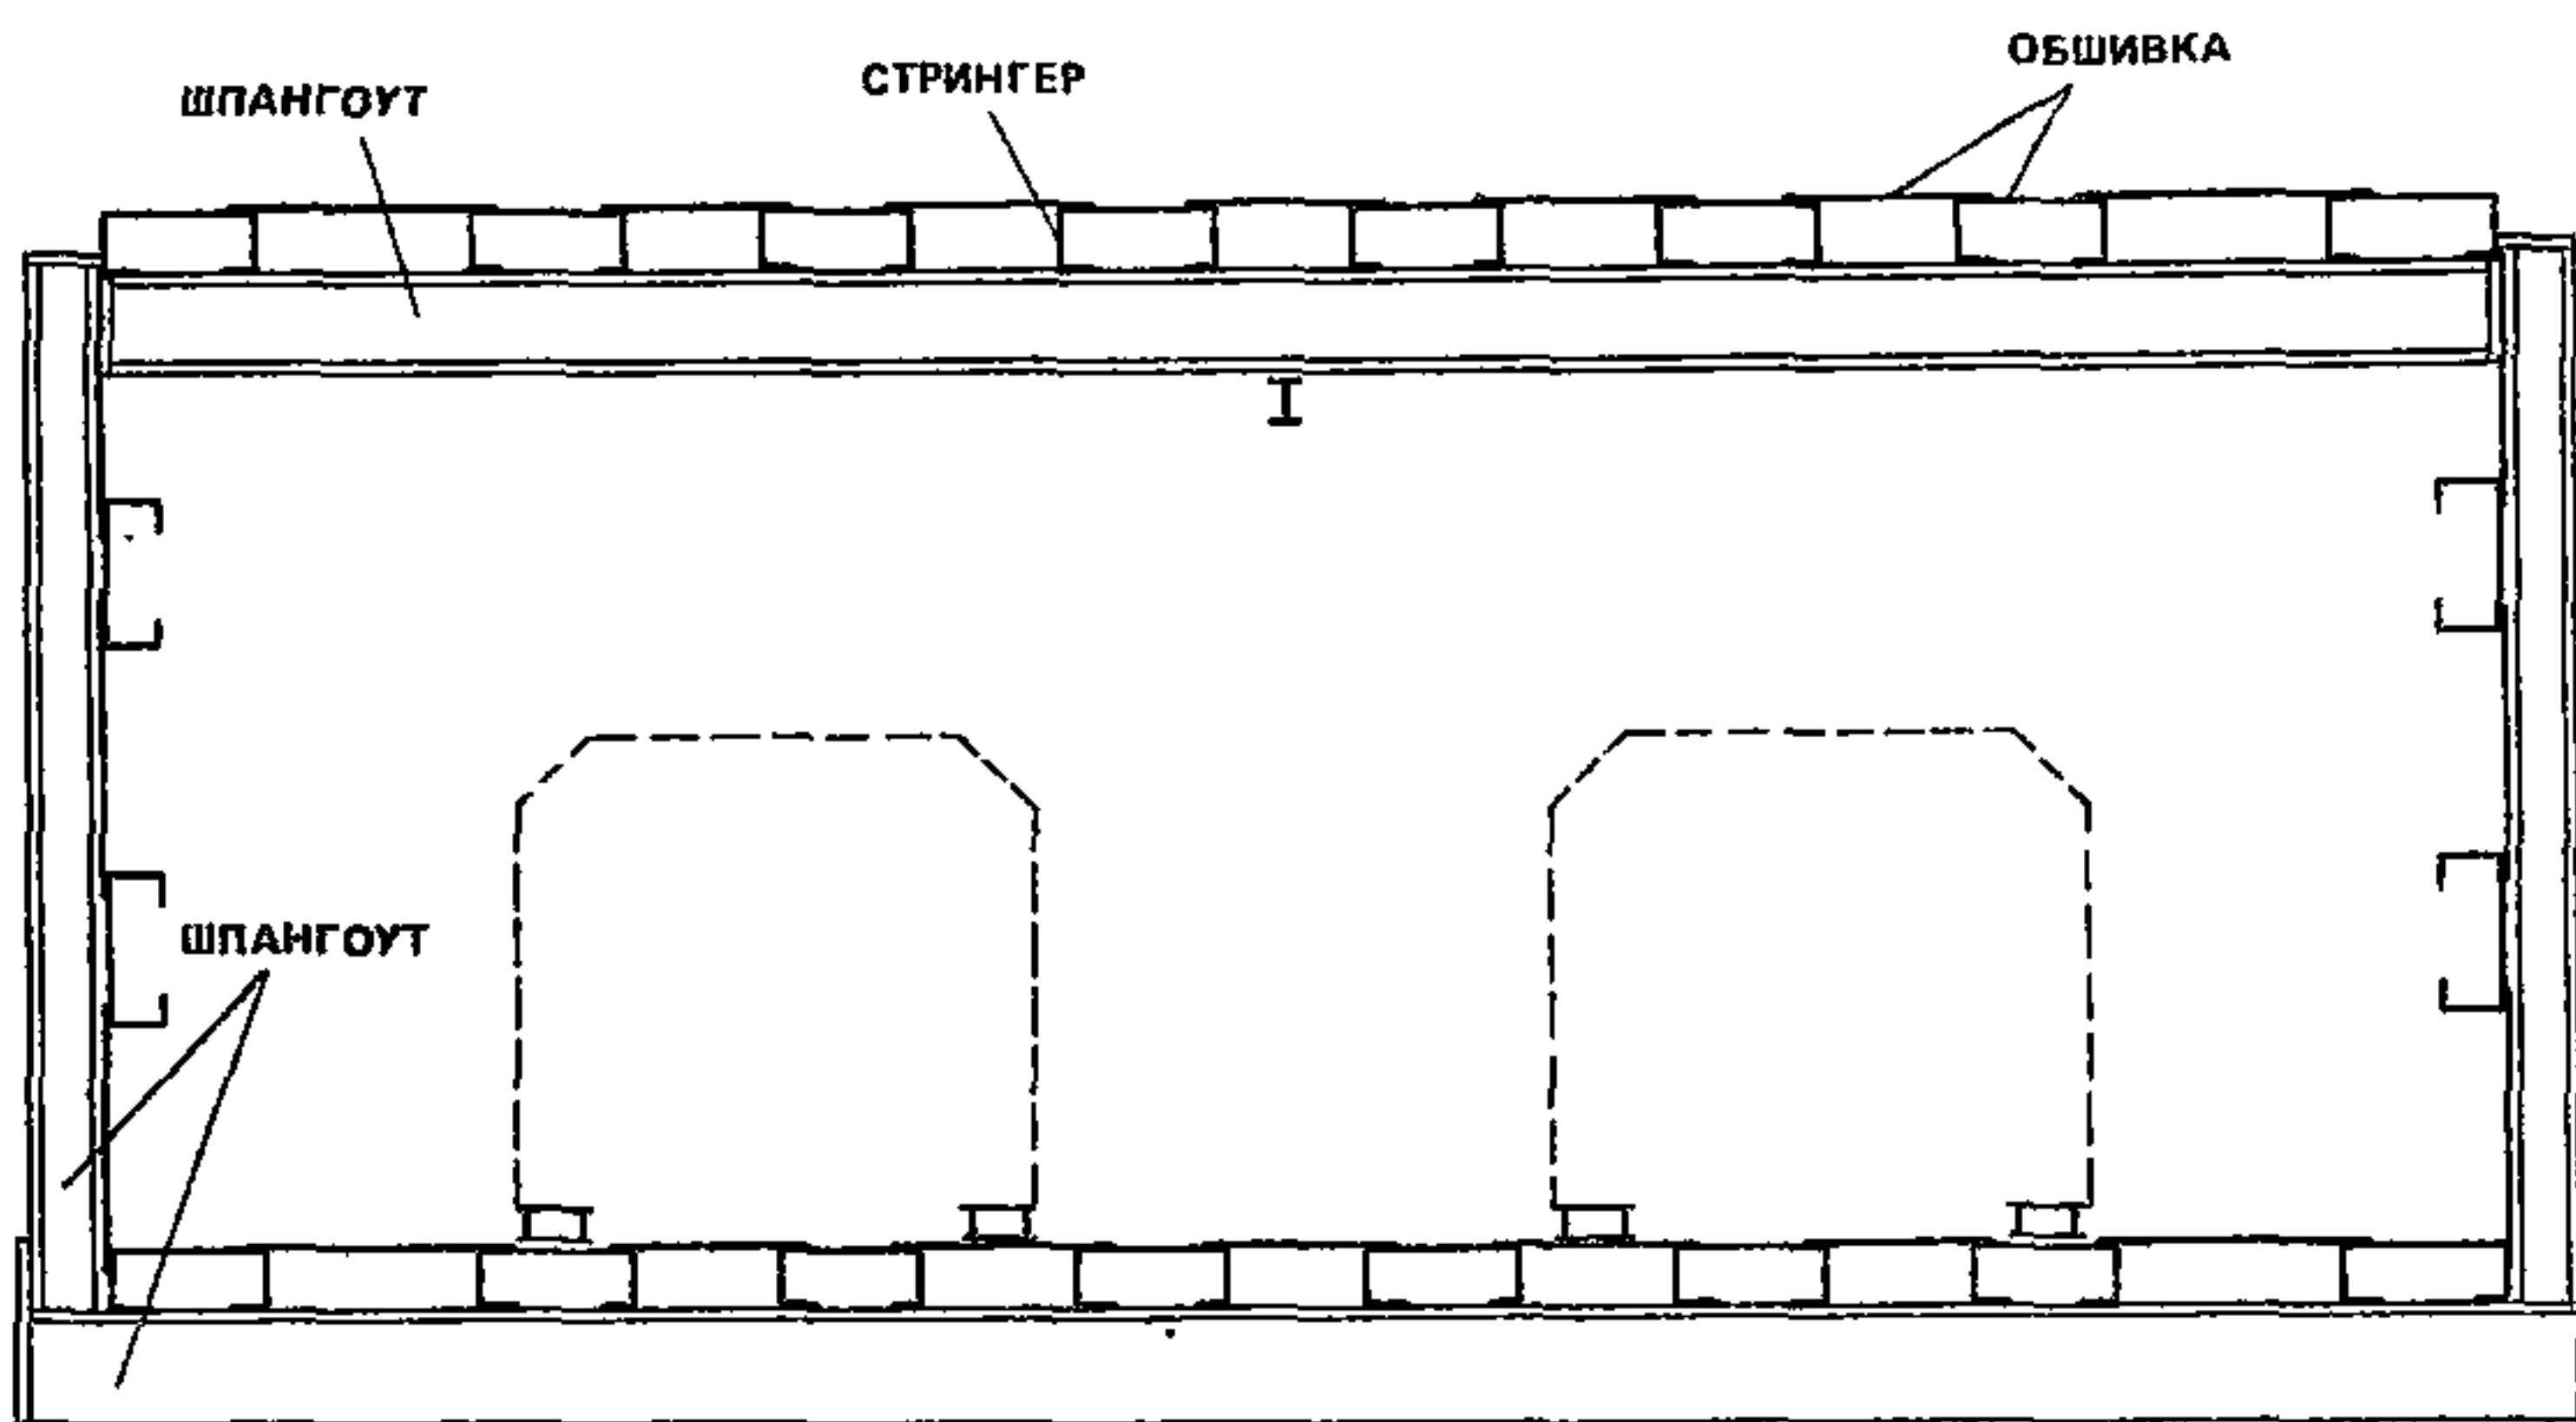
Поперечное сечение пролетного строения из прямоугольной оболочки с плоскими стеновыми панелями
